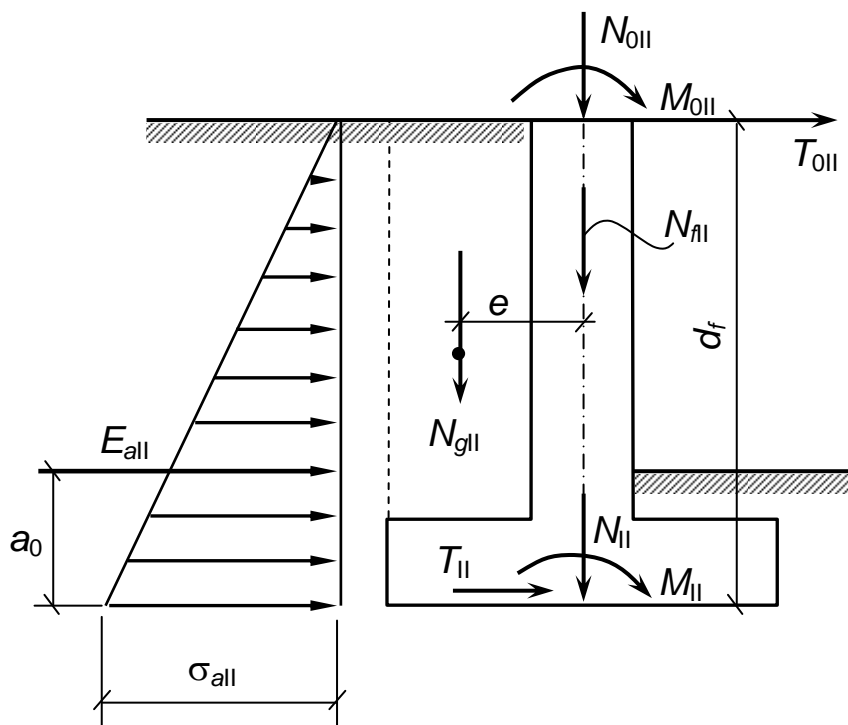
Расчетная схема внецентренно нагруженного фундамента
